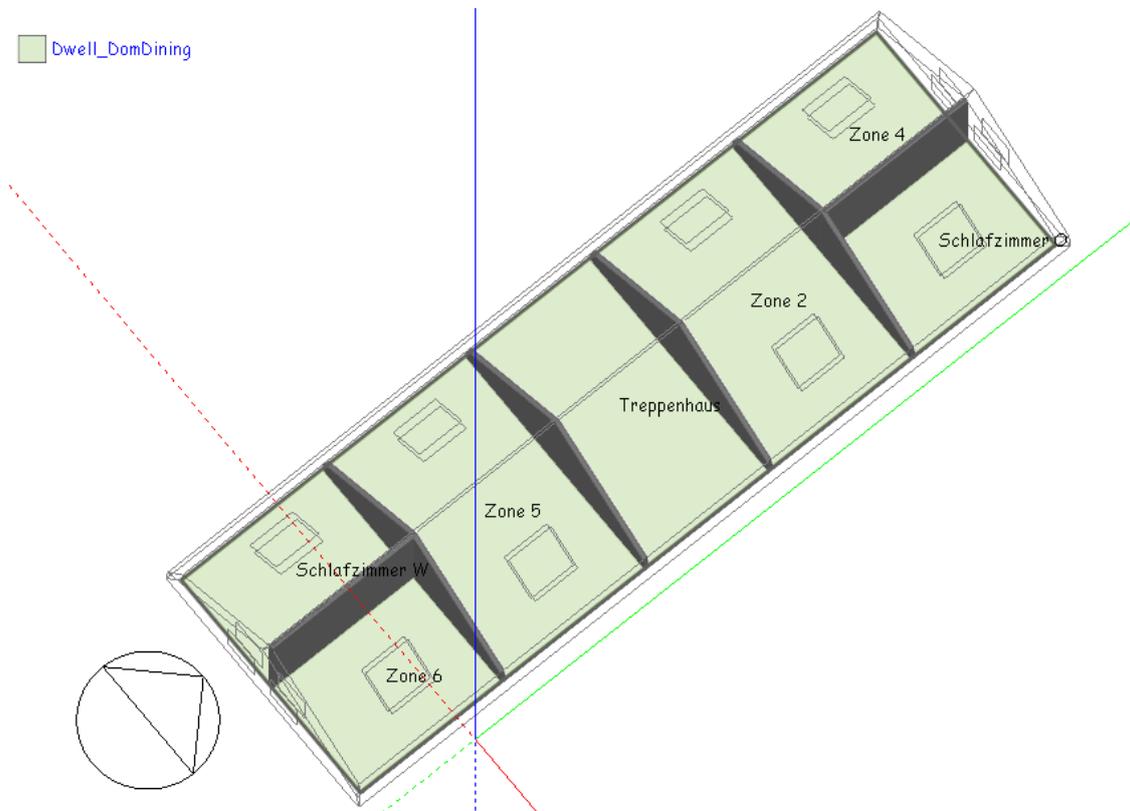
Modell Mehrfamilienhaus: Zonierung Dachgeschoss.
